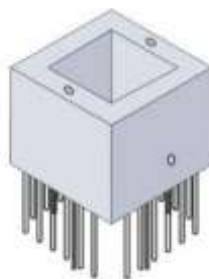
Фундаментний стакан типу СВ з арматурними випусками [4]
